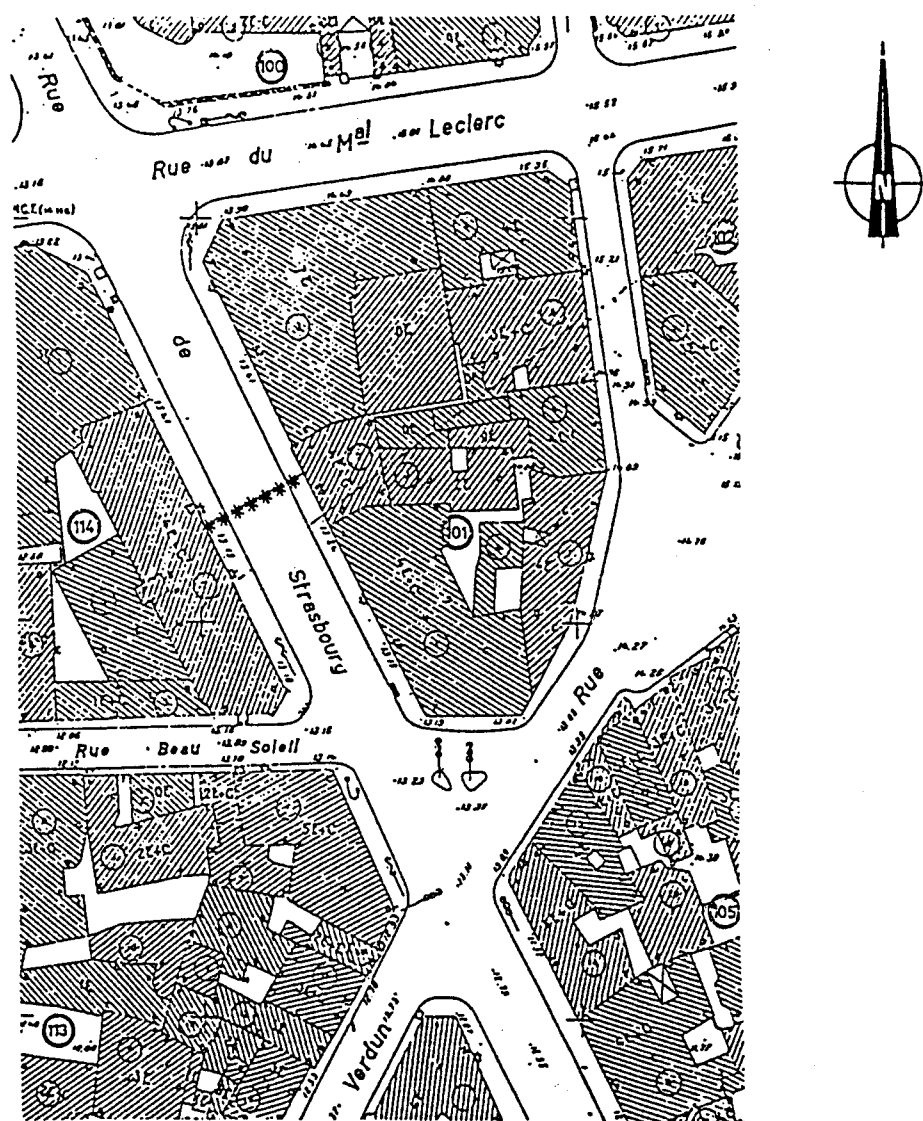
Localisation de la section d'étude () - Plan au 1/500ème
